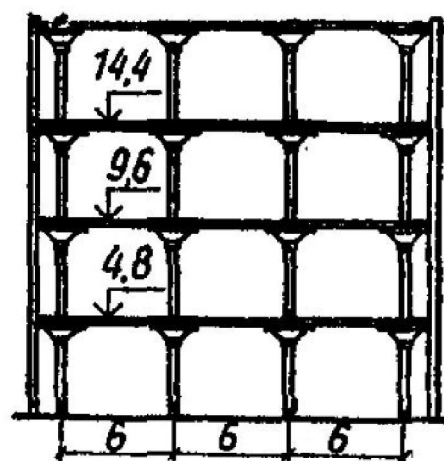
Конструкции многоэтажных промышленных зданий с безбалочными перекрытиями [1]
